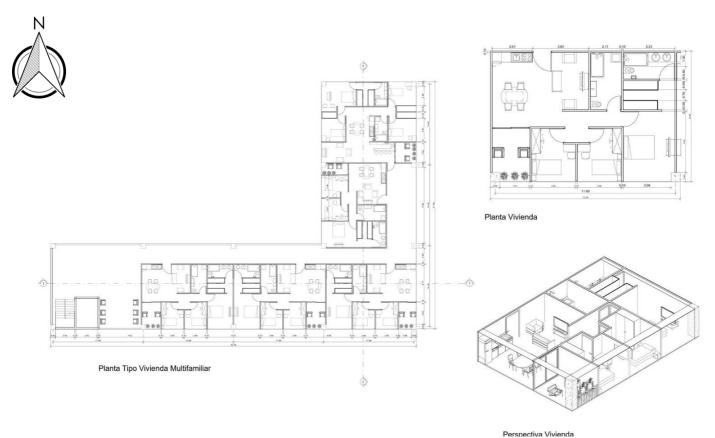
Segunda propuesta de diseño. Plantas e isométrico. Elaboración propia. 2022
